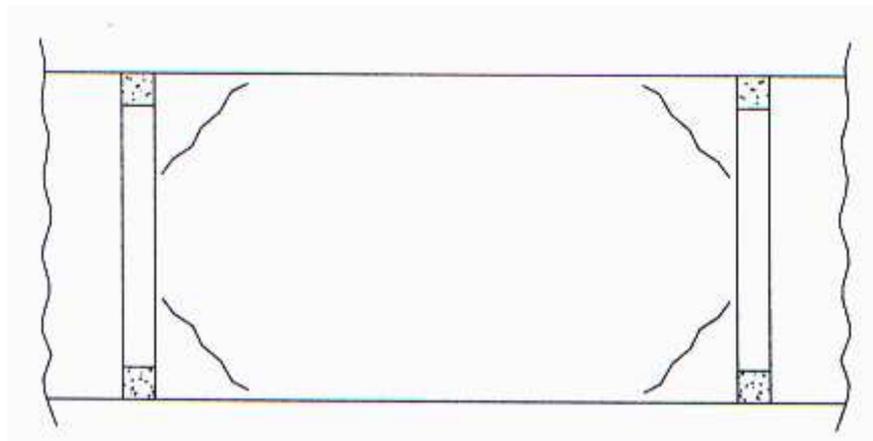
Configuração da fissuração por momento volvente
